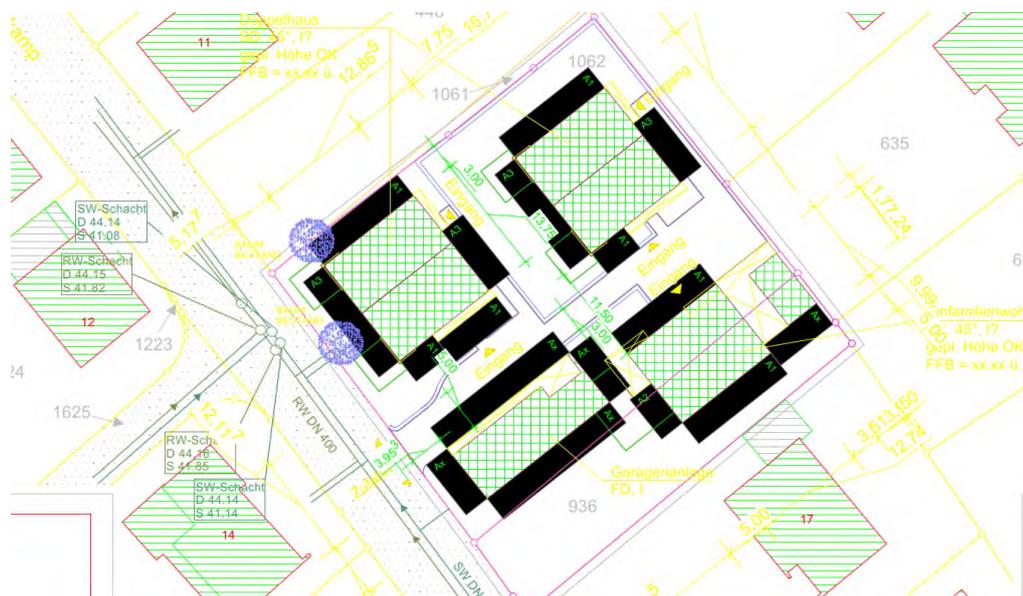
Städtebauliches Konzept, Baldauf Architekten, Stand 04.02.2020
